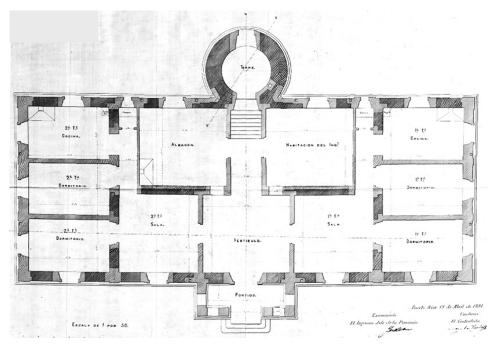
«Hoja 1ª Planta general». (AGPR, 1881)
